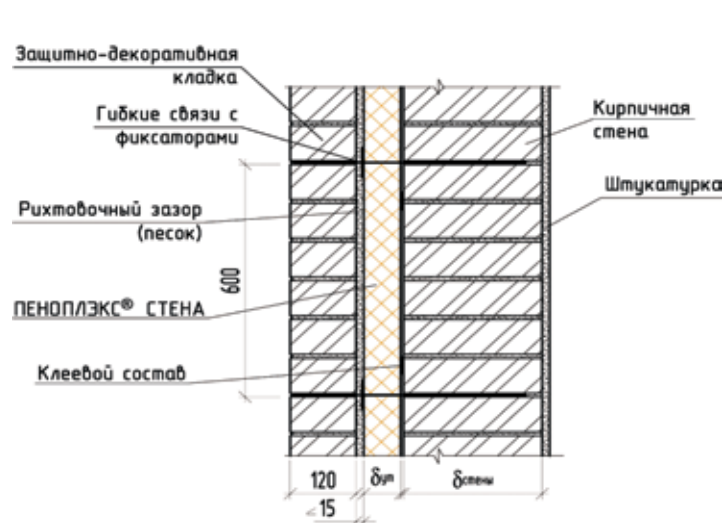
Конструкция наружной стены здания № 3 (кирпич – ПЕНОПЛЭКС Стена – защитно-декоративная кладка)
